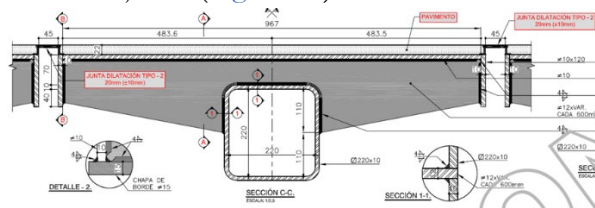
Sección de bandeja de forjado en losas basculantes de Skywalk
